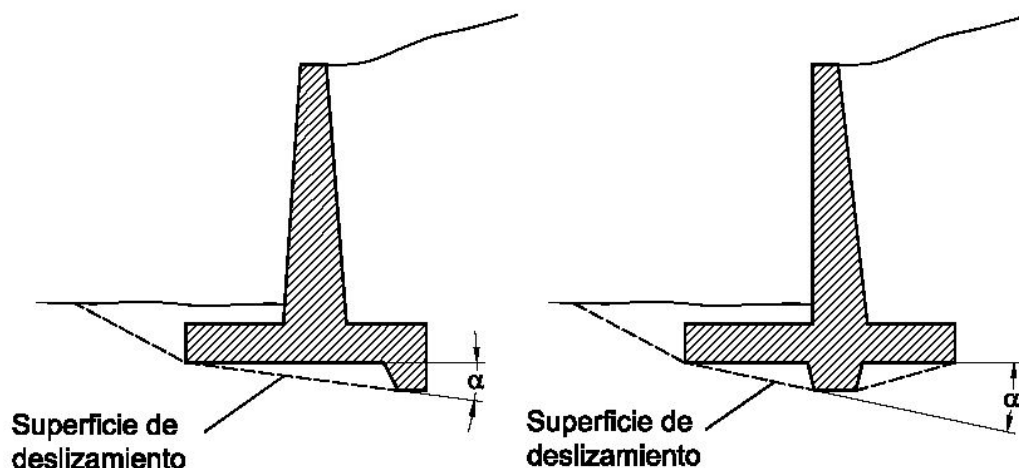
Posibles superficies de deslizamiento en muro con zarpa
